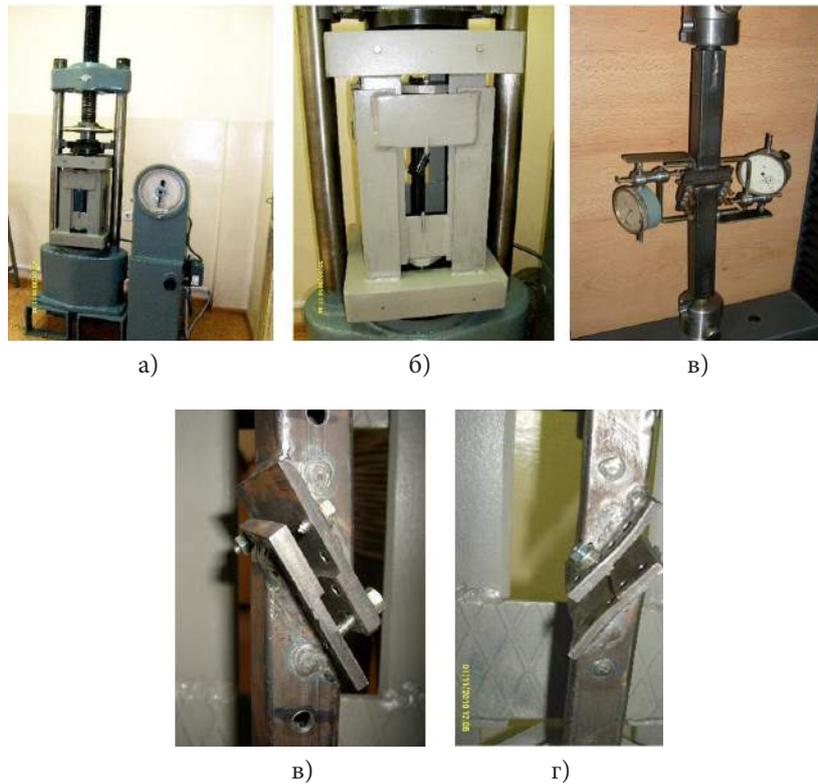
Снимки общего вида испытательной установки (а), ее реверсивной части (б), опытного образца с механическими индикаторами перемещений (в), опытного образца с болтовыми соединениями после их разрыва (г), опытного образца после разрушения из-за изгиба фланцев (д)
